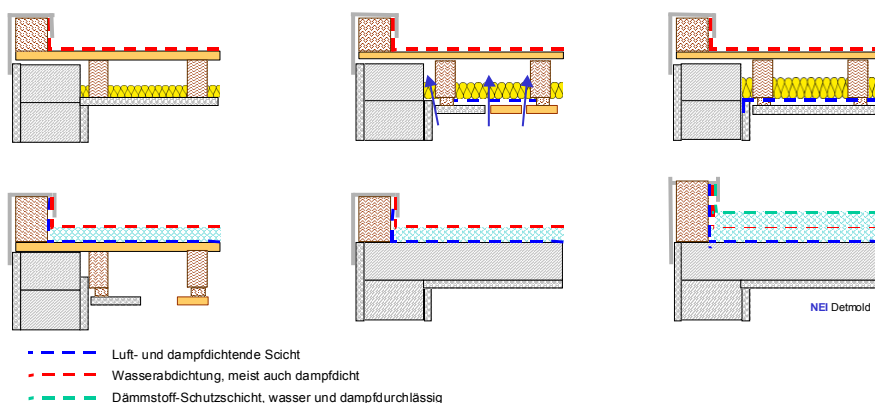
Flachdach-Konstruktionen (oben Kaltdächer, unten Holz-Warmdach, Beton-Warmdach und Beton-Umkehrdach)
